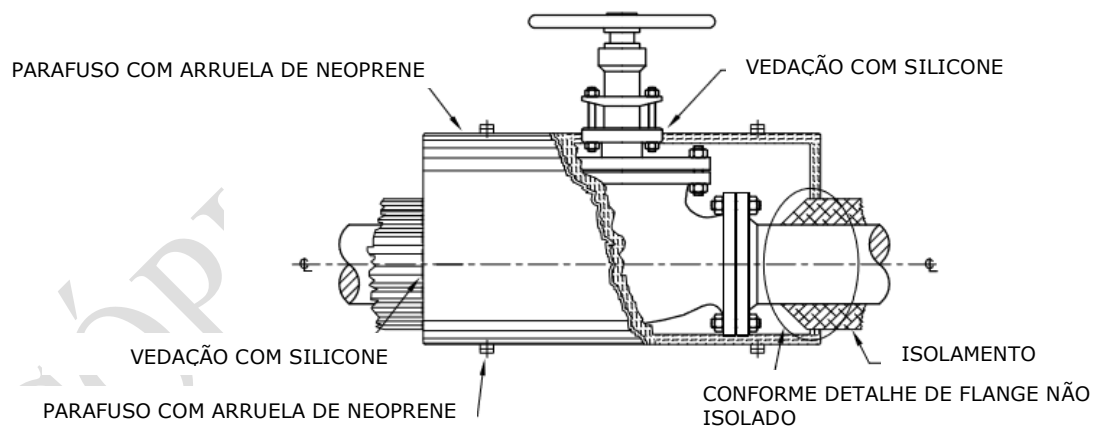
Montagem do revestimento – Válvulas com Flanges isolados
